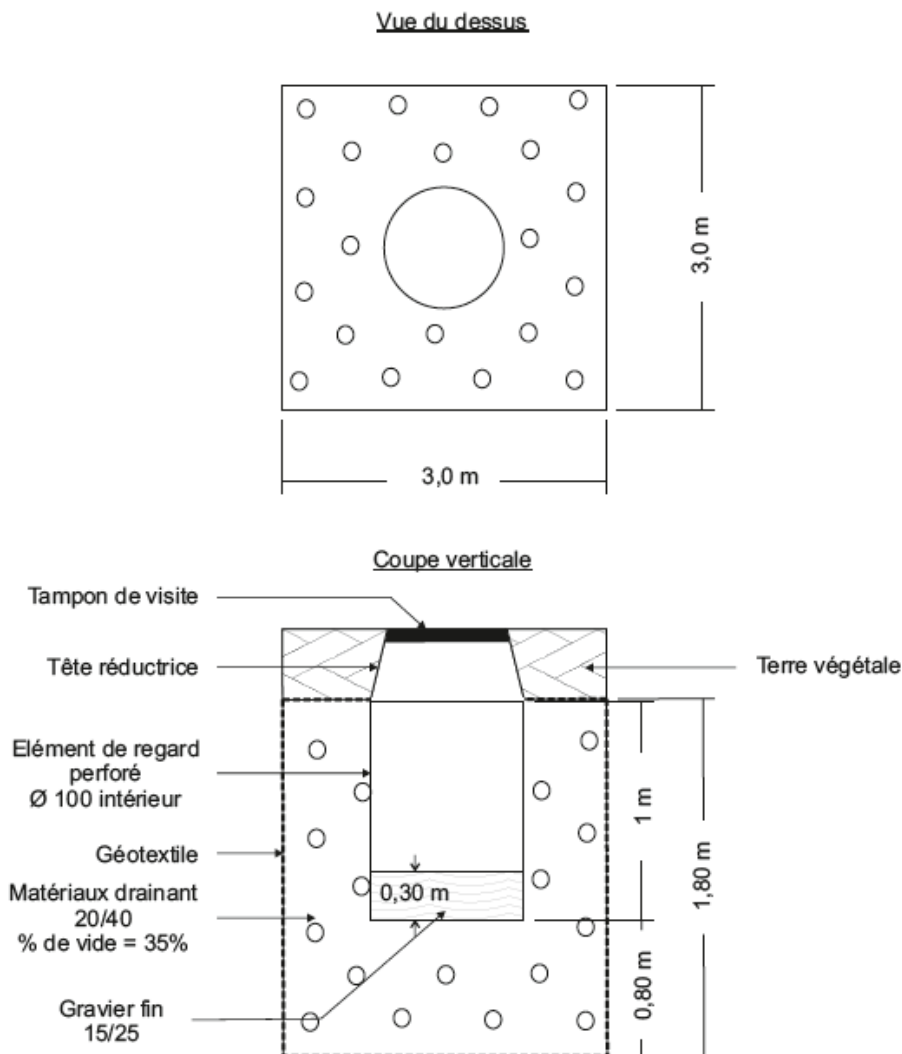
Schéma de principe d'un puits d'infiltration pour une surface imperméabilisée de 130 m²
